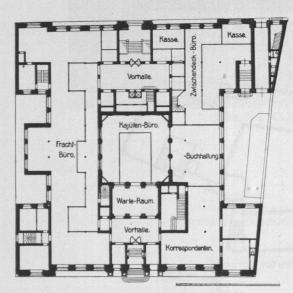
Hamburg-Amerika Linie, Grundriß des Erdgeschosses.
